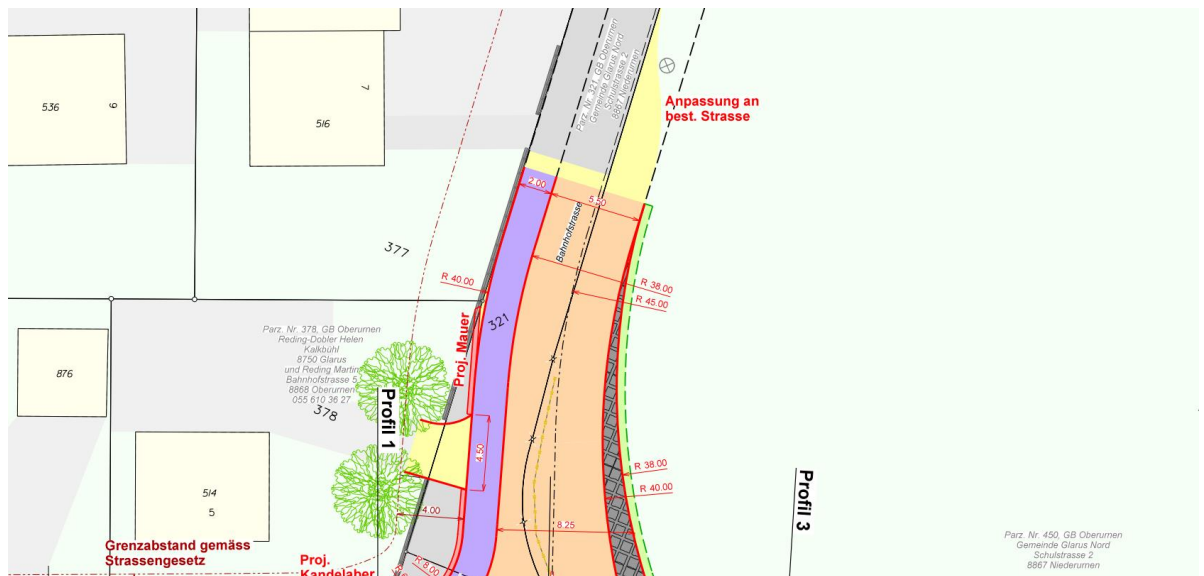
Situationsplan Ausschnitt Weiterführung Gehweg entlang Bahnhofstrasse
